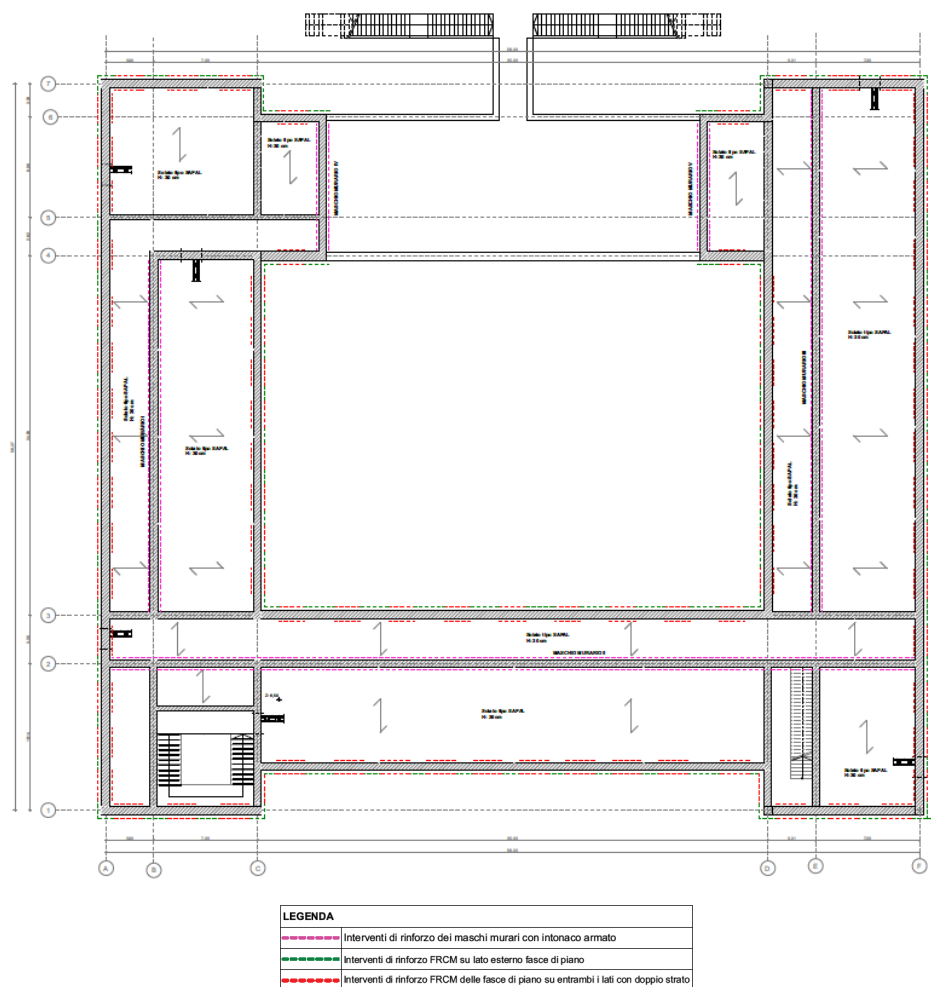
Pianta carpenteria stato di progetto – Piano primo
